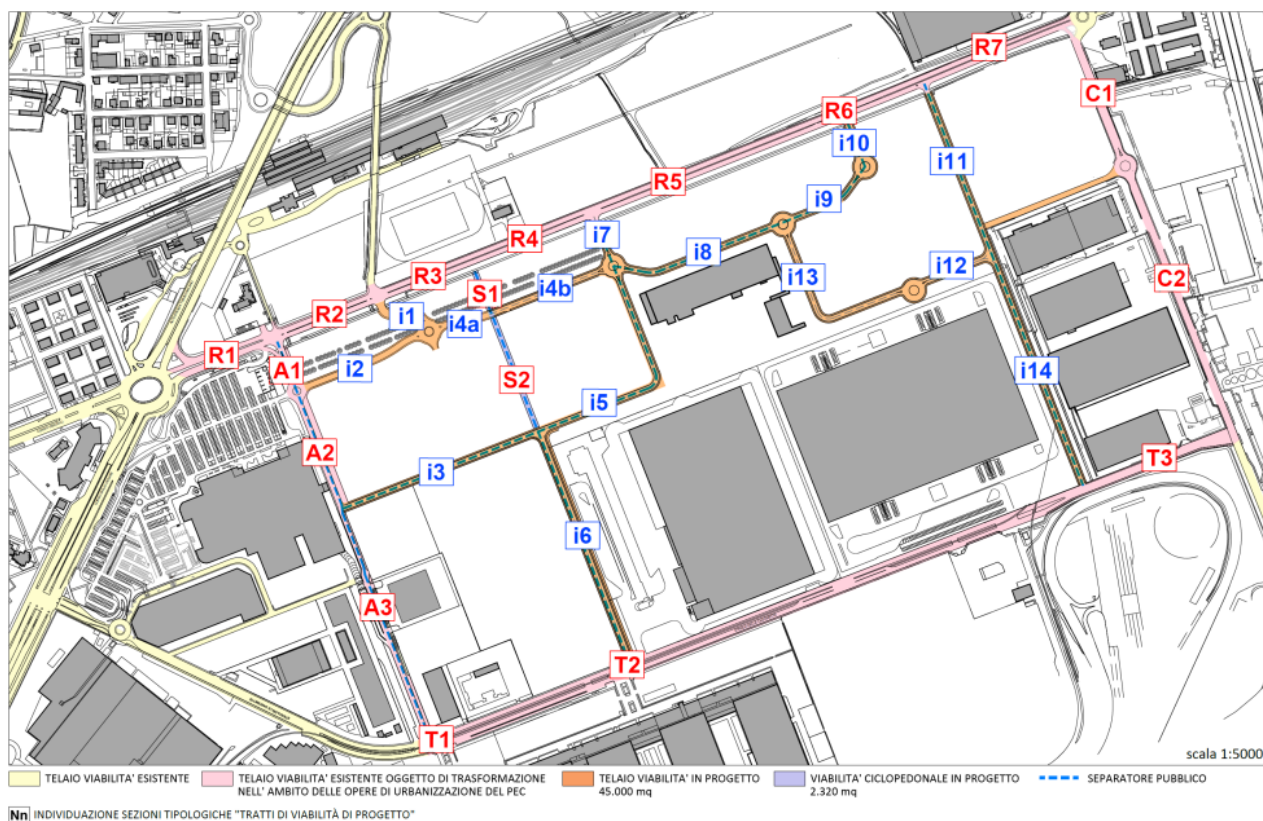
Telaio viabilità – progetto su planimetria di rilievo
